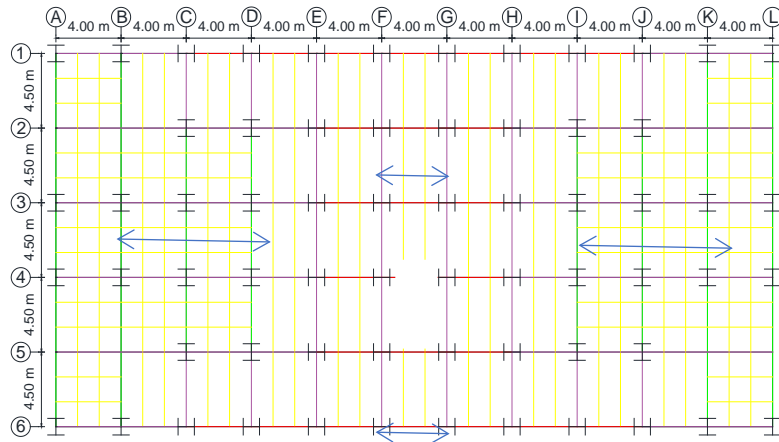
Planta de entrespiso de la edificación híbrida con panel Vierendeel 1m.
